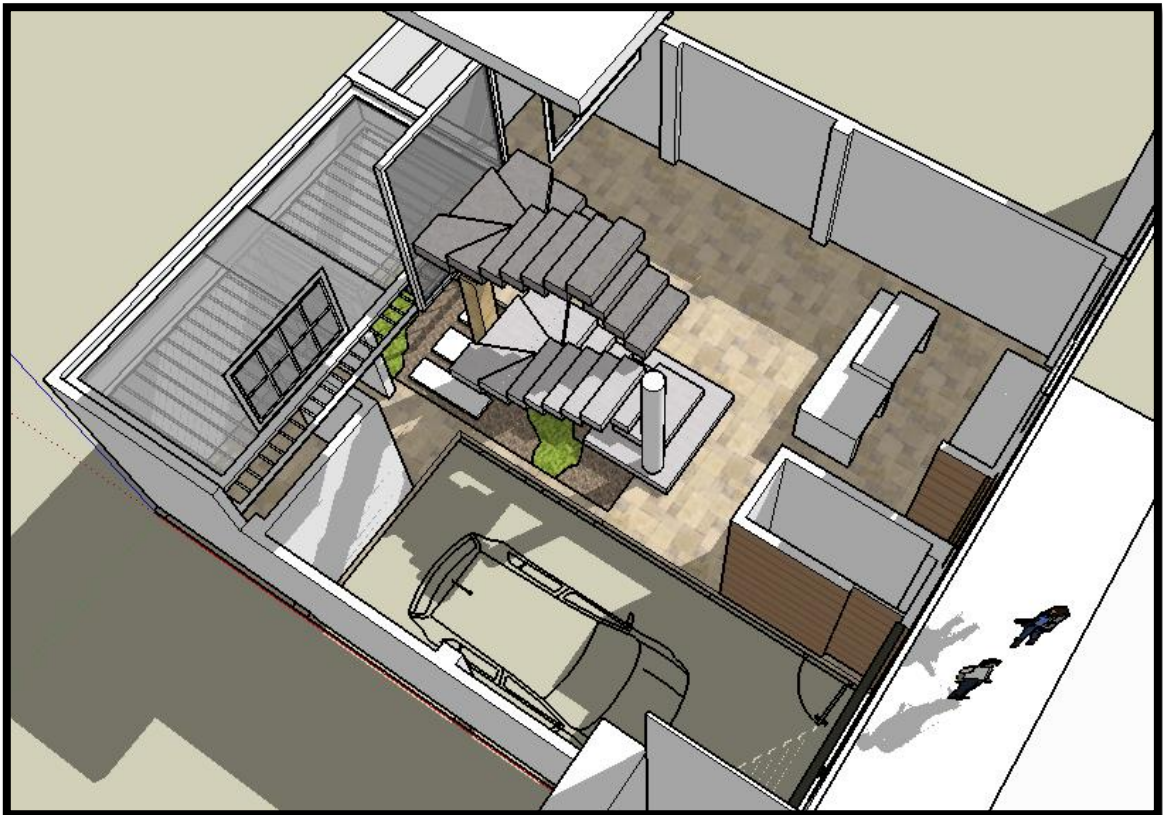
Prototipo fachada vivienda familiar en Barrancabermeja/Santander
